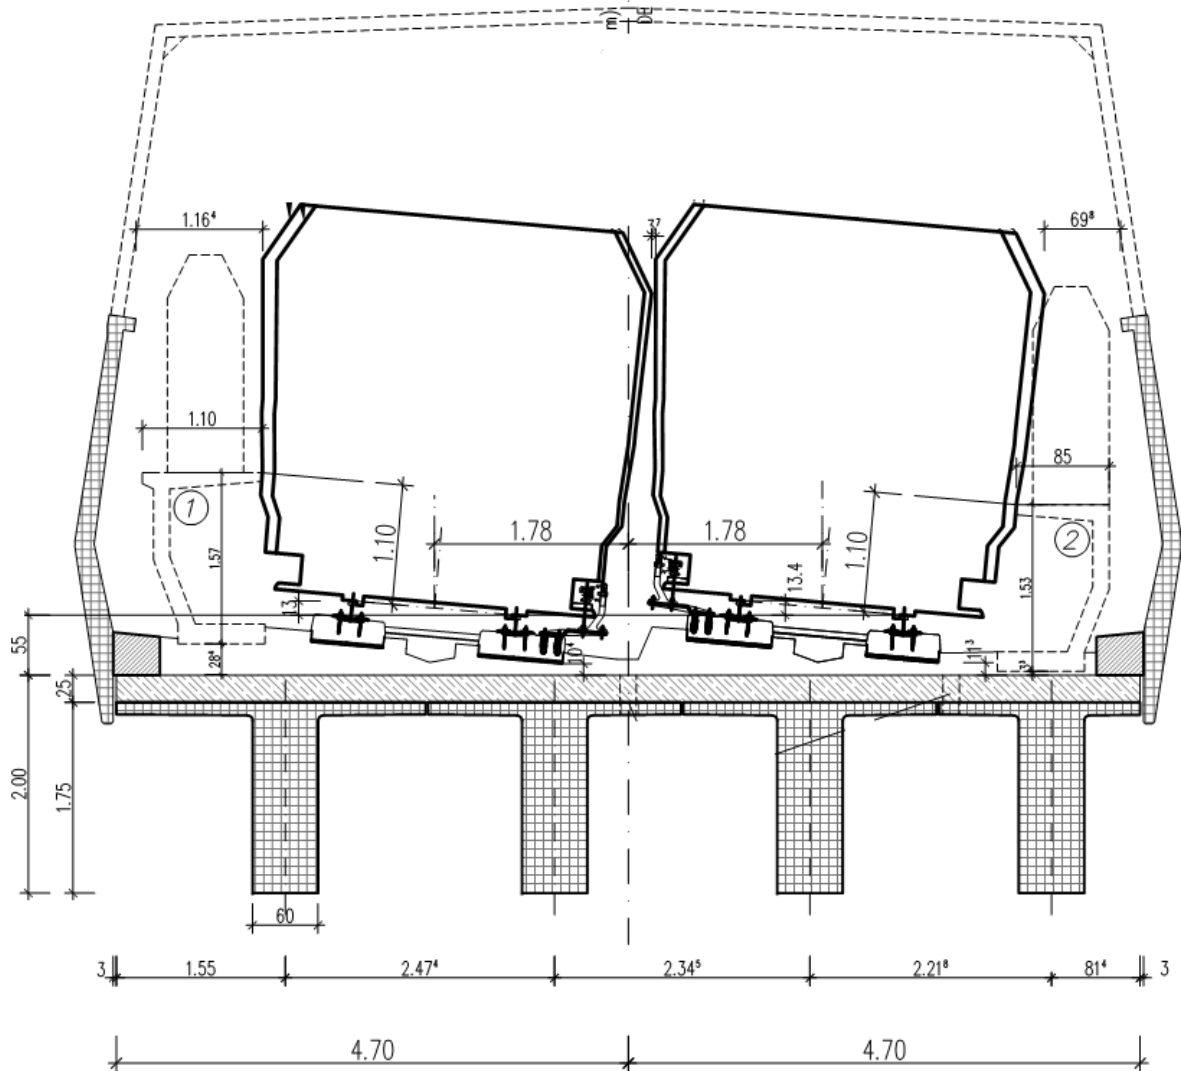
Profil en travers du viaduc métro d'Alger (Echelle : 1/50).
